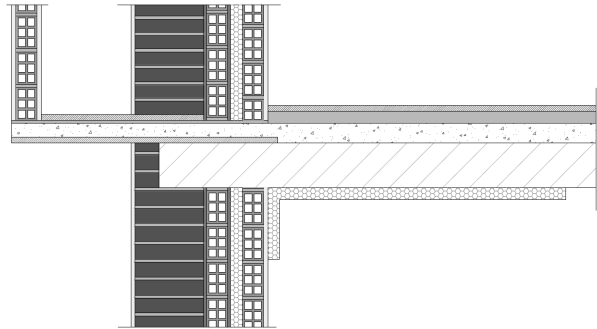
Fachada-Forjado (balcón). Zona Oeste. Mejora.
